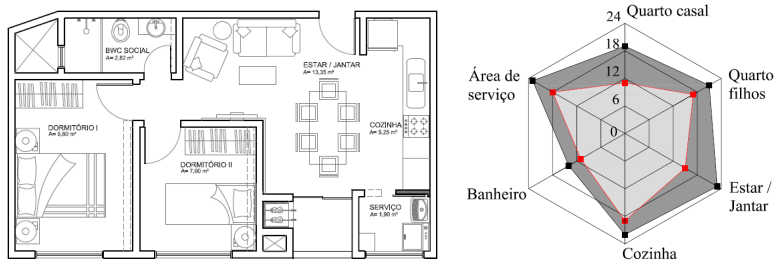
a) Planta baixa Tipo B. b) Modelo radar Tipo B com adaptações.
